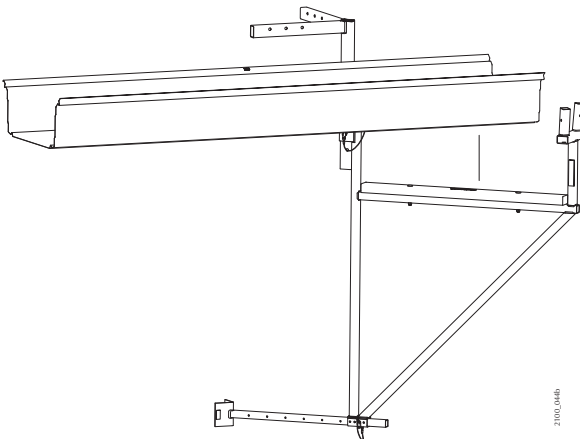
Montage des Laufblechs an der Eckplattformkonsole
